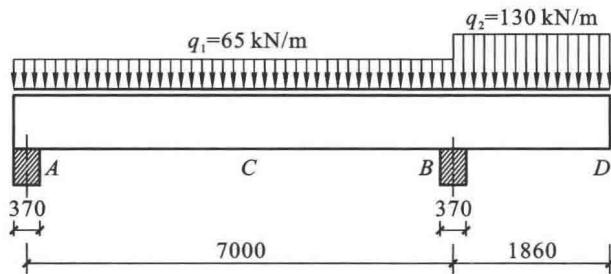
承受均布荷载的钢筋混凝土悬臂梁
